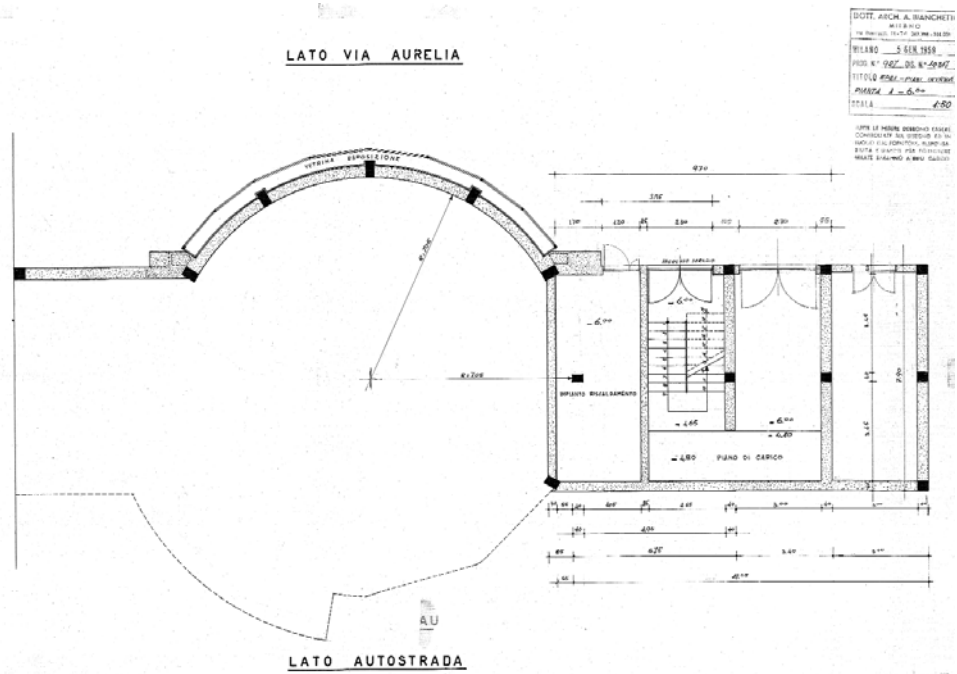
Pianta del piano interrato (quota -6,00 livello Aurelia) (AAB)
